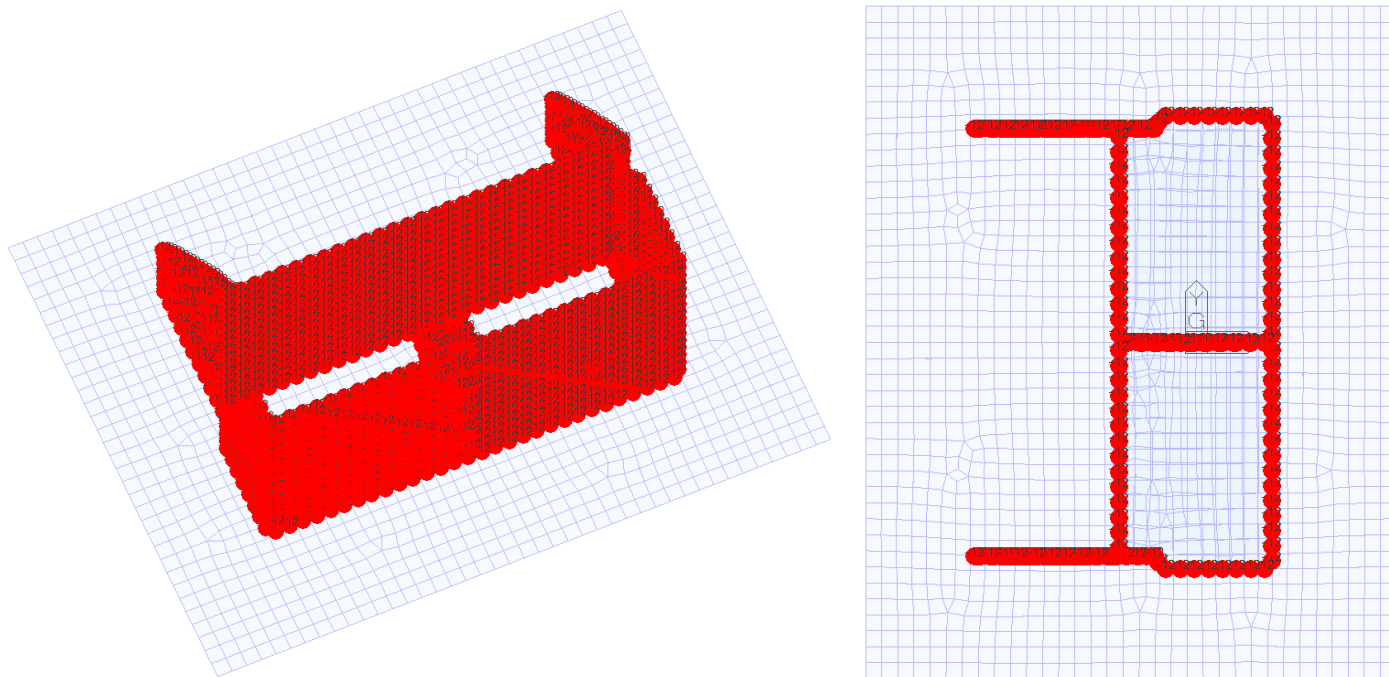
Applicazione del carico termico da ritiro sul modello FEM – Vista 3D - Vista in pianta
